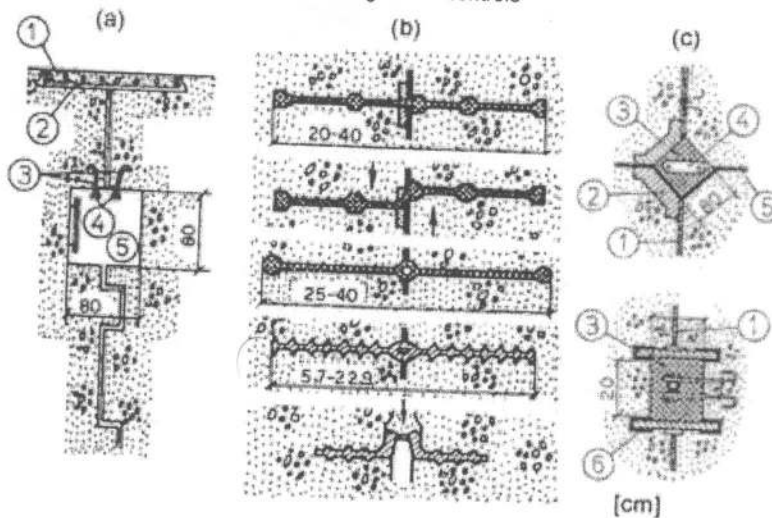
Disposition de joints internes et waterstops dans un barrage sur fondation rocheuse (a) : (1) dalle de béton armé (2) base bitumineuse (3) ancrages, (4) plaque de cuivre, (5) regard
